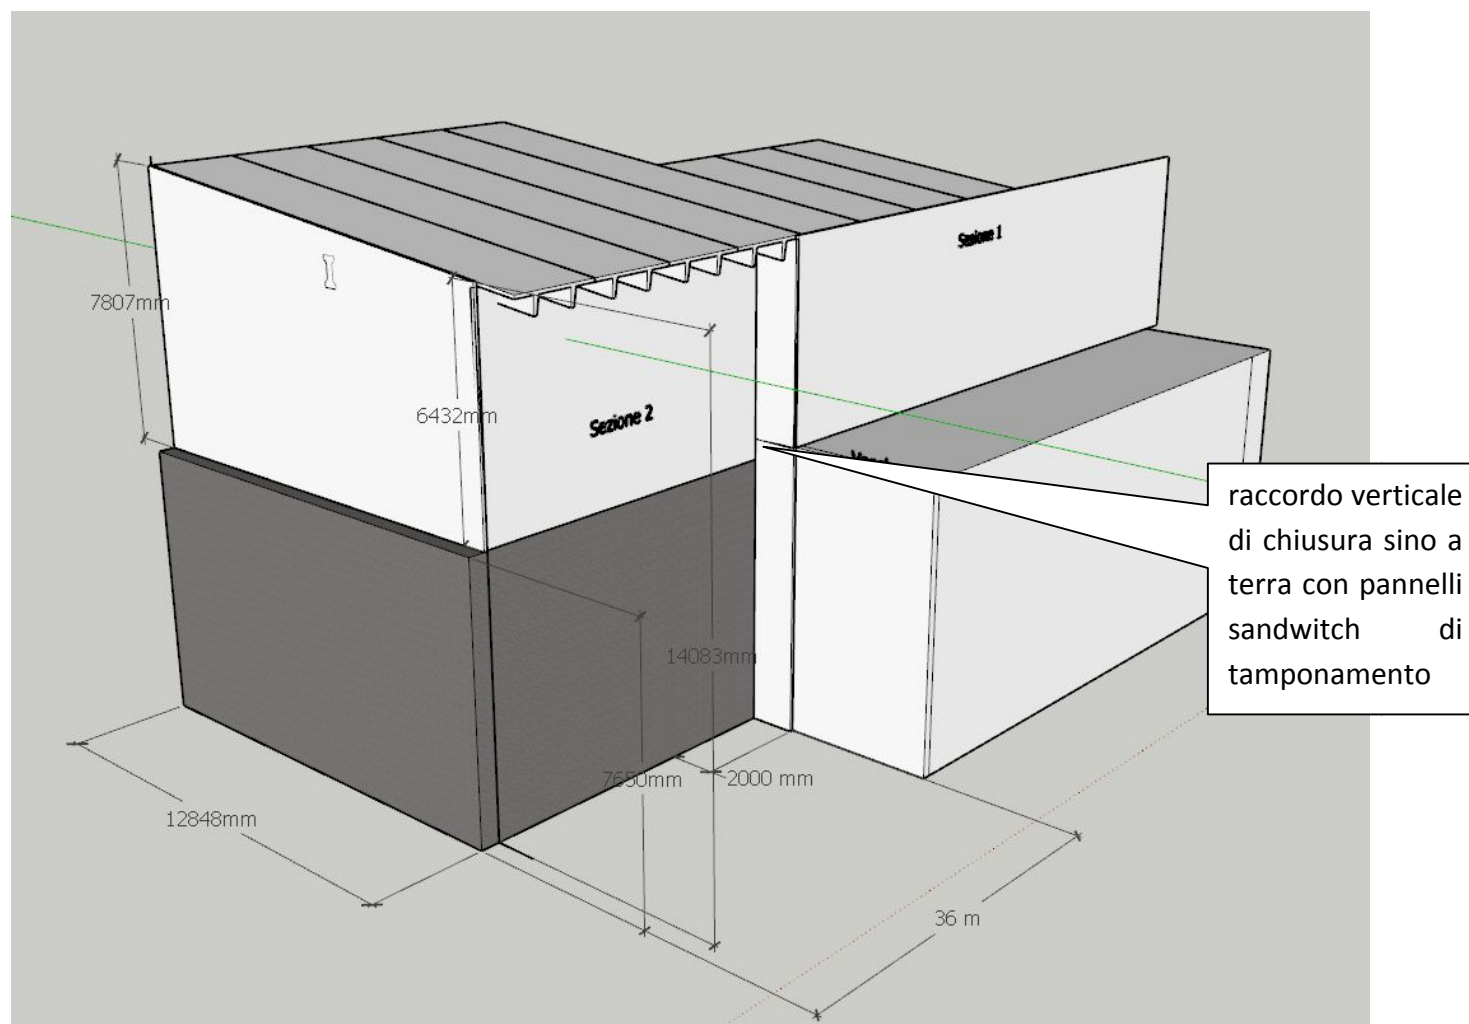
Zona di chiusura tettoia tra sezione 1 e sezione 2
